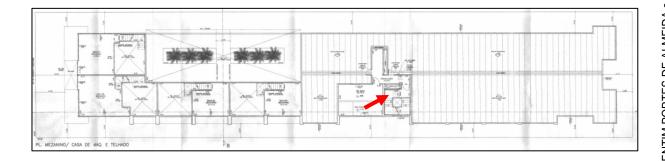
Laje de cobertura do sétimo pavimento. Destaque para trecho da estrutura degradada pela exposição às intempéries.
